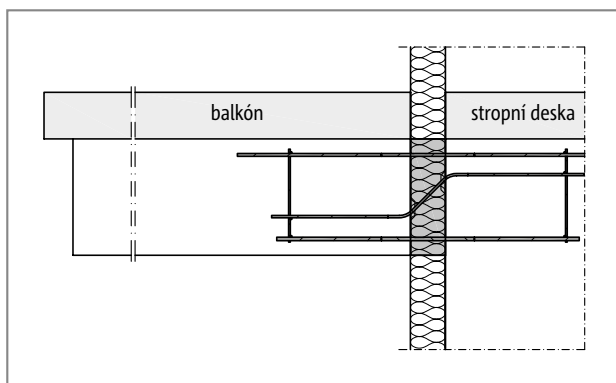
Schöck Isokorb® typ SXT: Balkónová konstrukce s volně vyloženými průvlaky (prefabrikovaný balkón)
